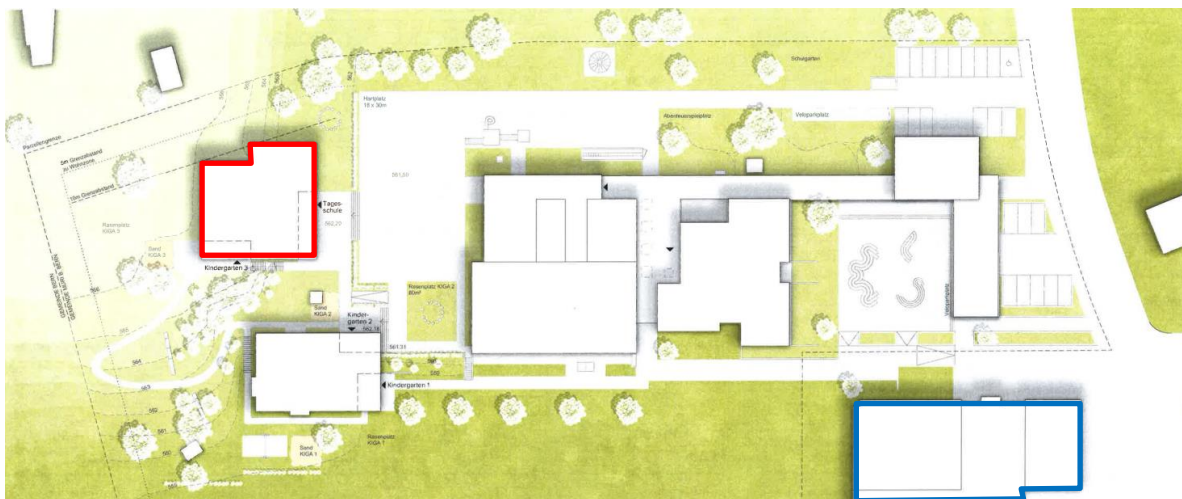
Machbarkeit eines Erweiterungsbaus (rot) und bestehendes Kirchgemeindehaus (blau); Plan Hausammann Architekten
